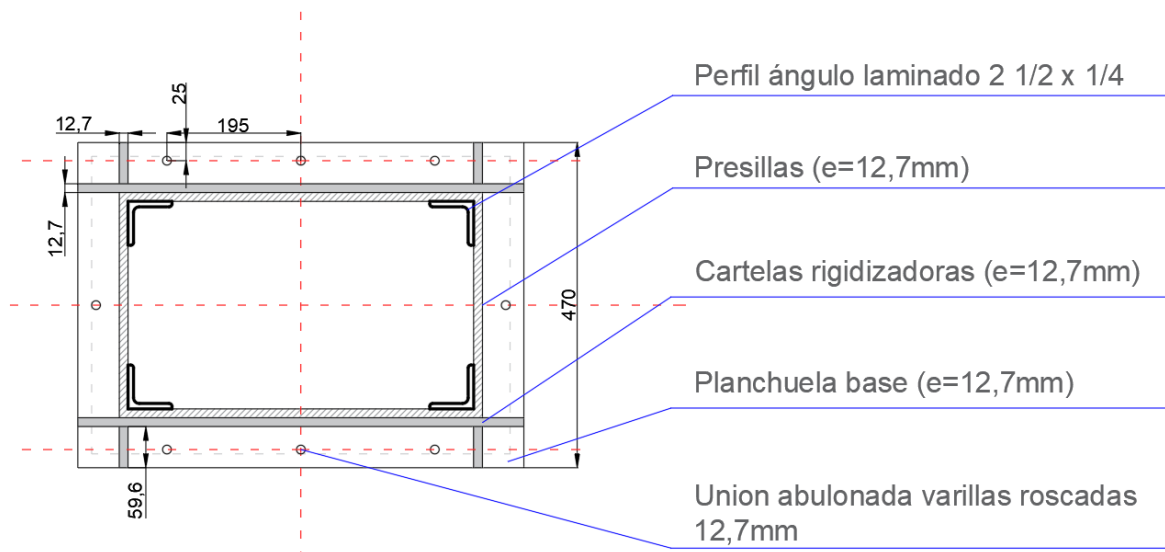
Detalle constructivo de la unión placa base – cimentación
